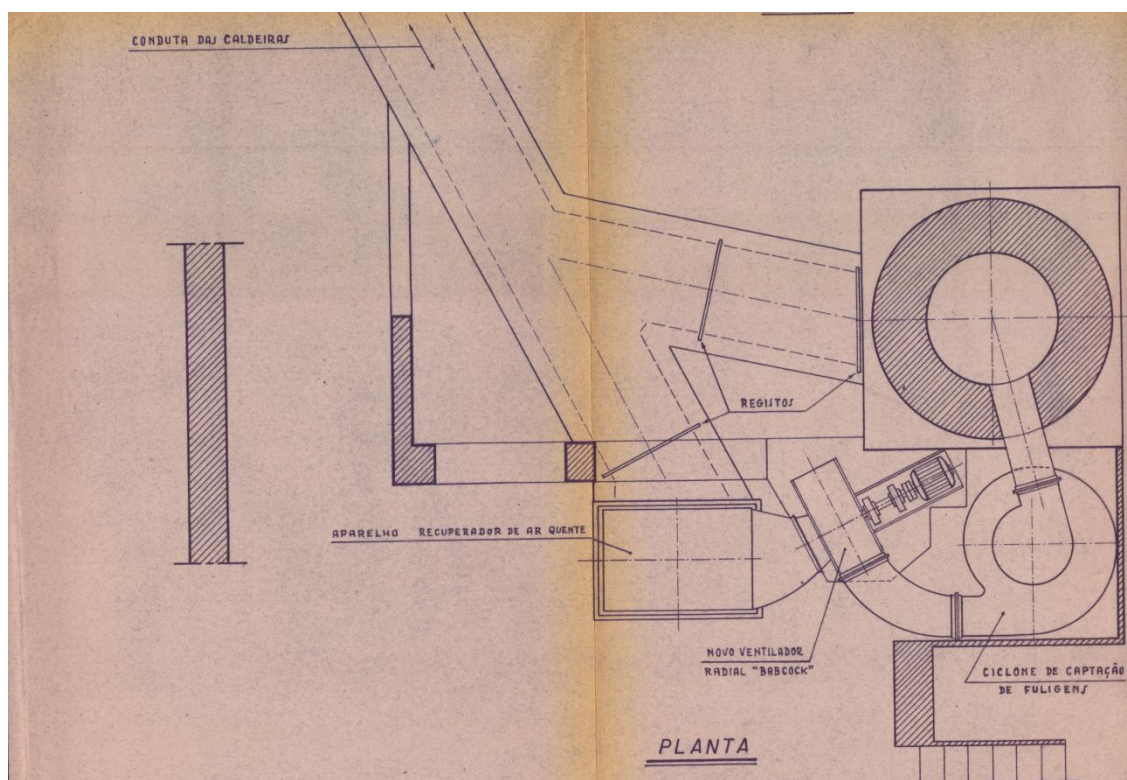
Planta das tubagens de ligação à chaminé de fumo negro. Arquivo da Fundação Robinson (Imagem cedida pela Fundação Robinson)
